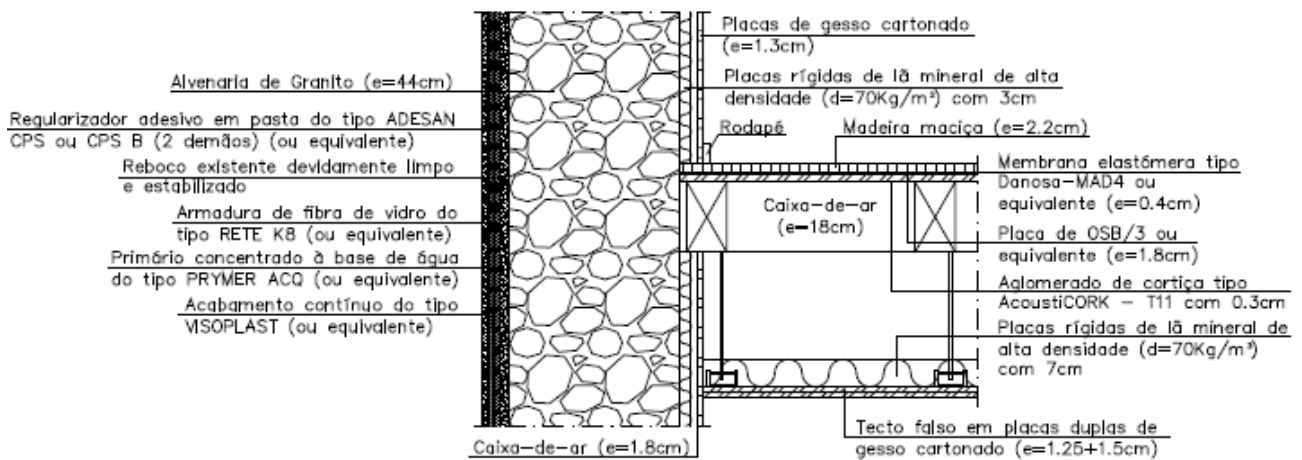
Pormenor de ligação entre a parede de fachada e o piso intermédio (Projeto de CT)
